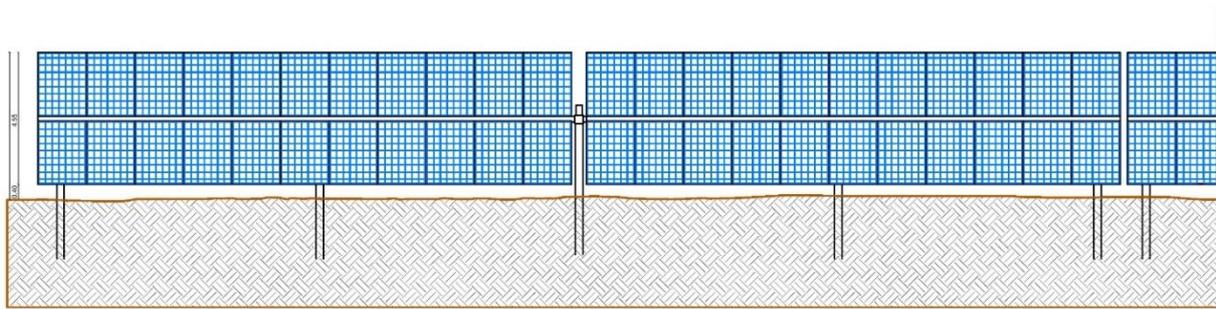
Dettagli strutture fotovoltaiche
